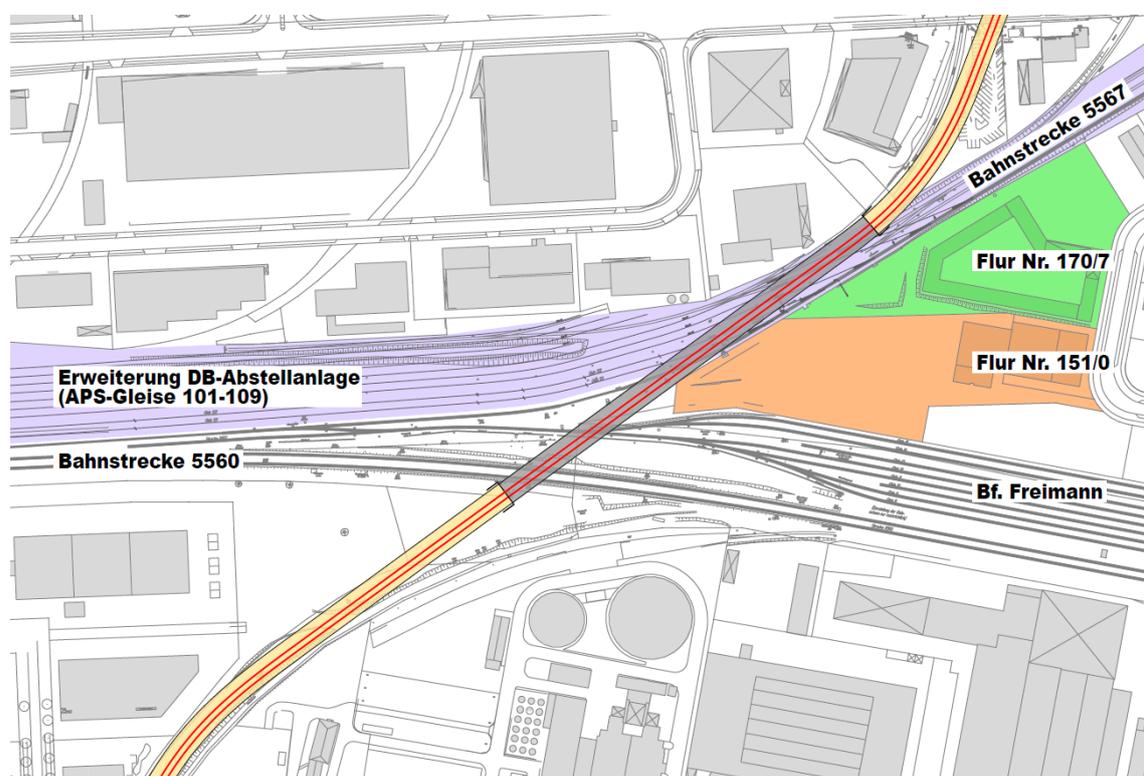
Lageplan, Variante 1 - Schrägseilbrücke
